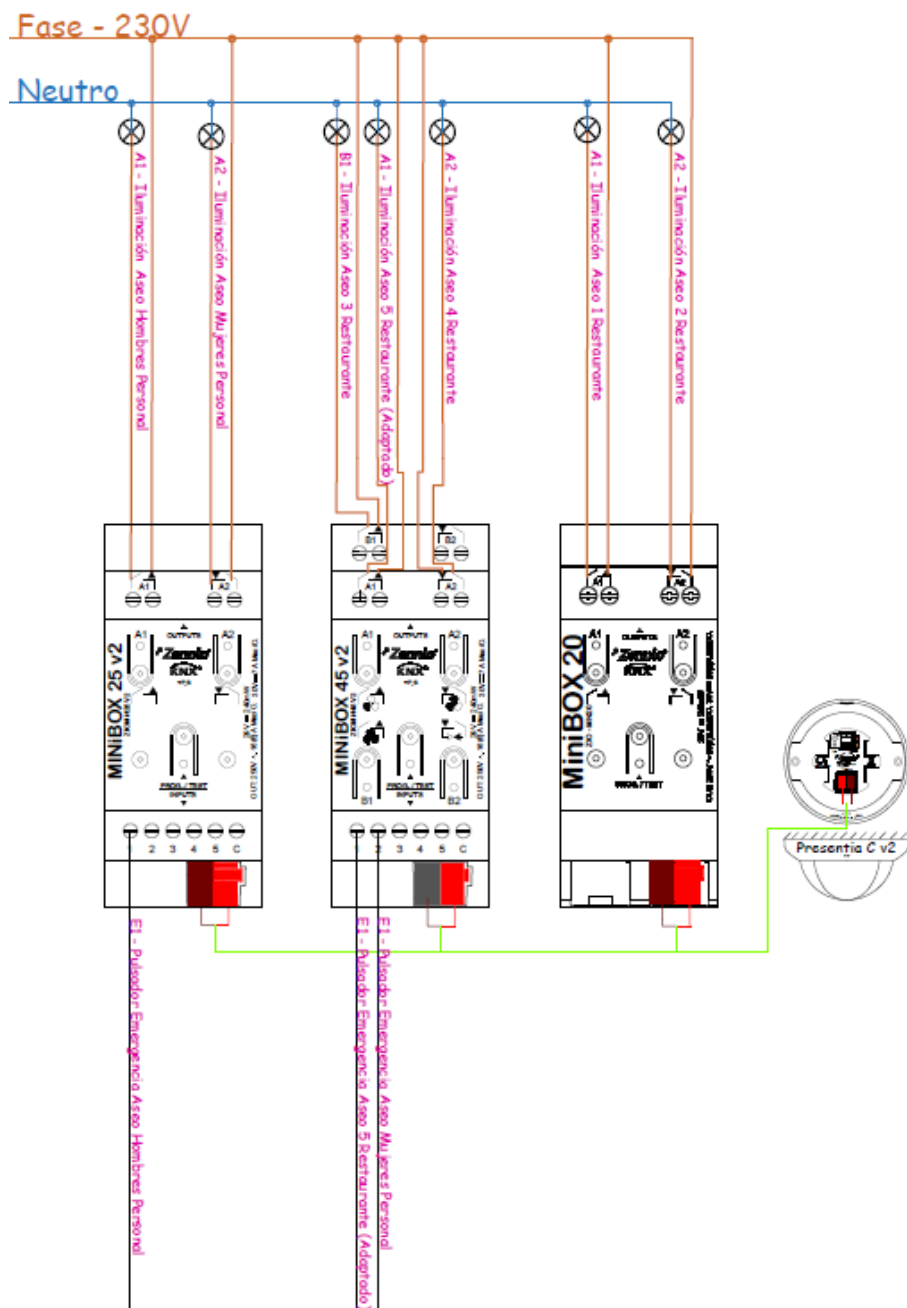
Conexionado del sistema proyectado para la zona de los baños de la planta baja.
